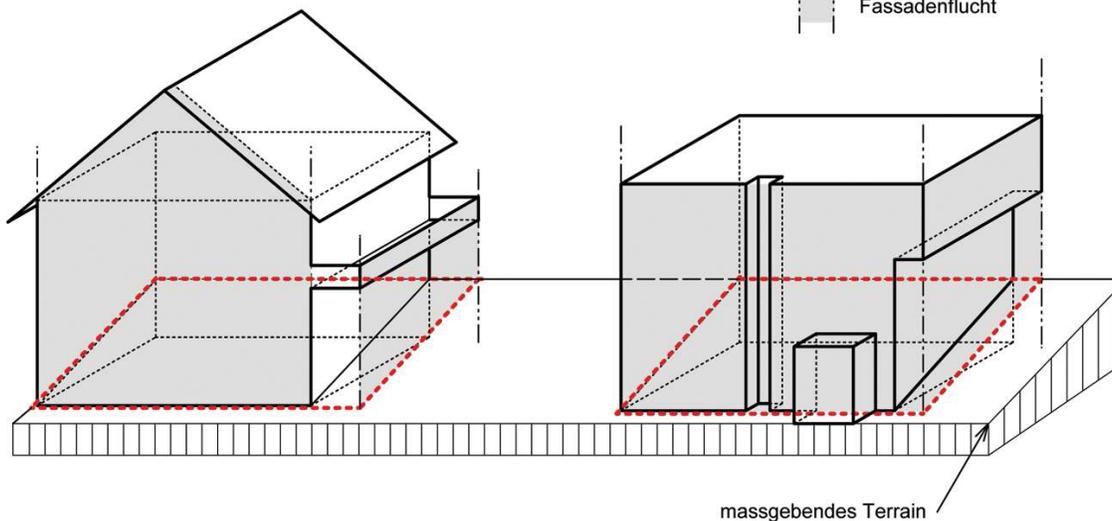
3.2 Fassadenflucht und Fassadenlinie
